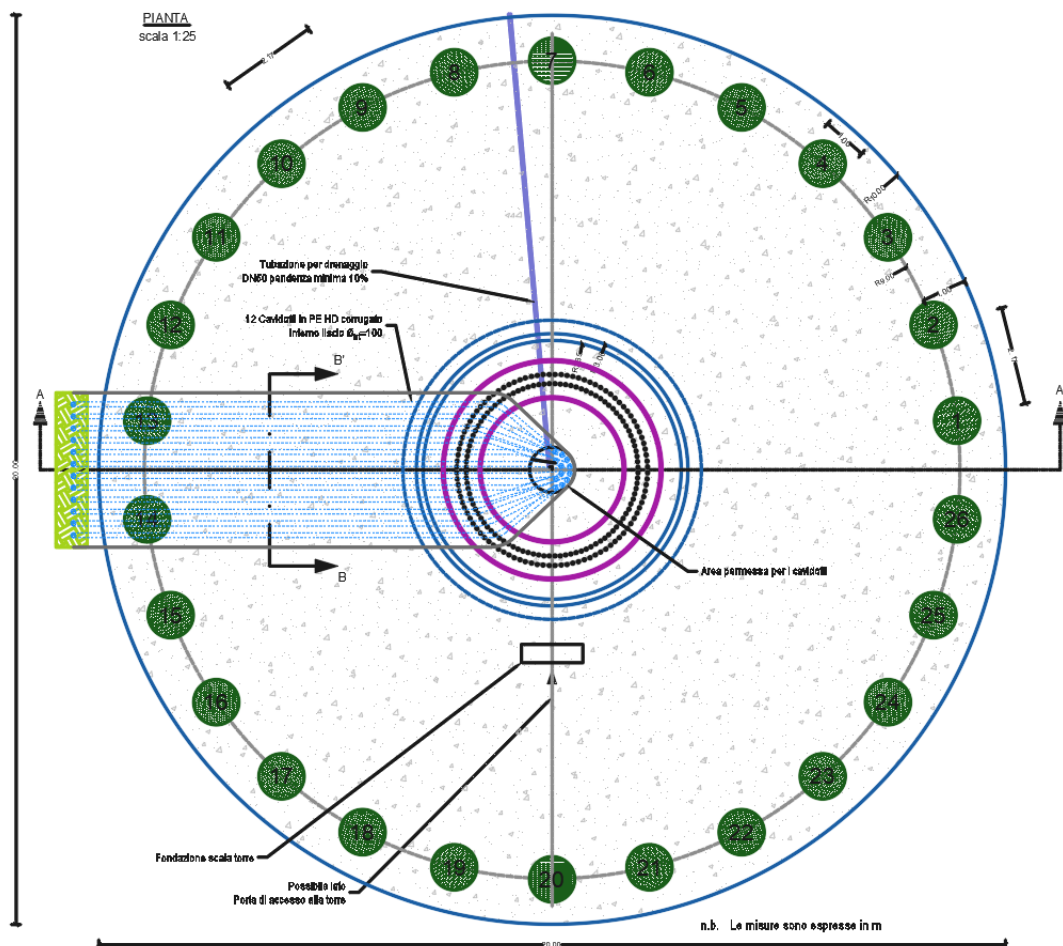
Pianta del plinto con indicazione dei pali di fondazione
